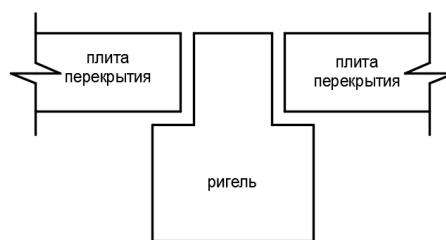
Схема опирания плит перекрытий на ригель таврового сечения
